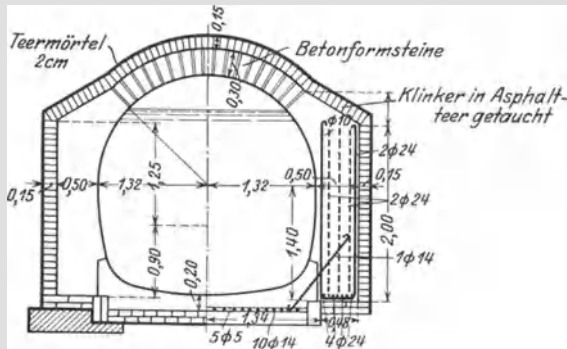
Stollenquerschnitt in einer Gipsstrecke. Maßstab 1 : 100.
